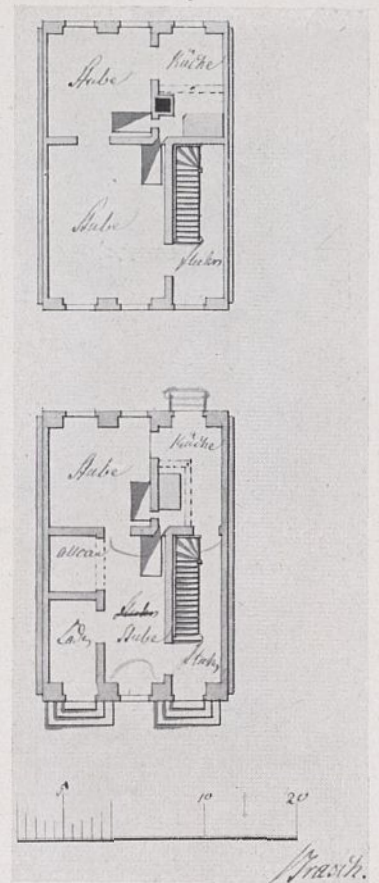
Neuruppin, Zeichnung zum Wohnhause für den Kürschner Krausnick.
